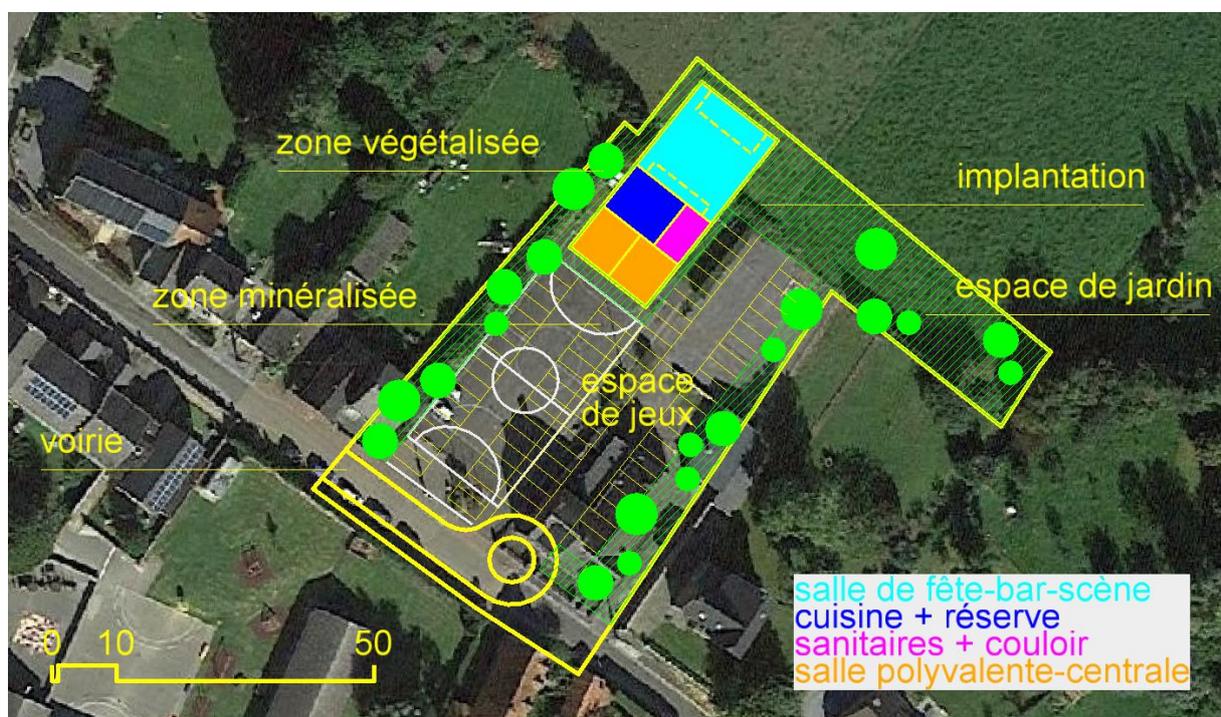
Proposition – seconde alternative d'implantation (Source : Google Earth / Aménagement sc - 2018)
